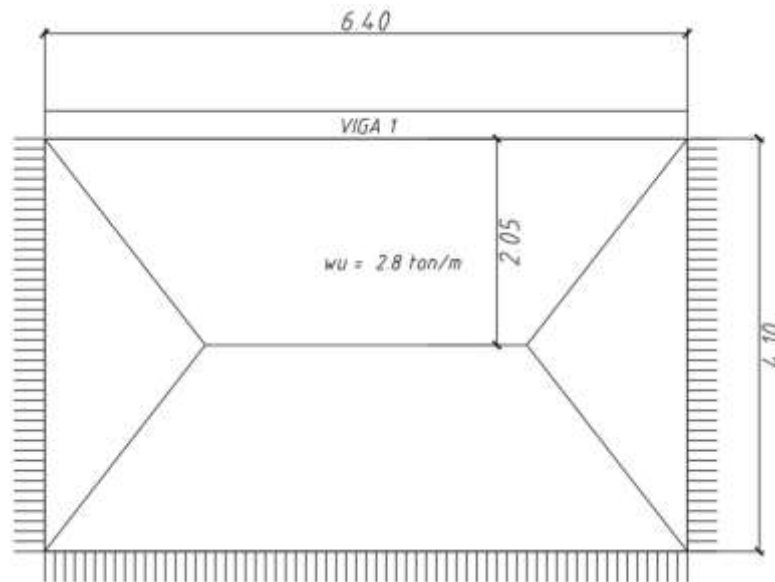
Cargas últimas de la losa maciza en viga 1 mediante el método del sobre
